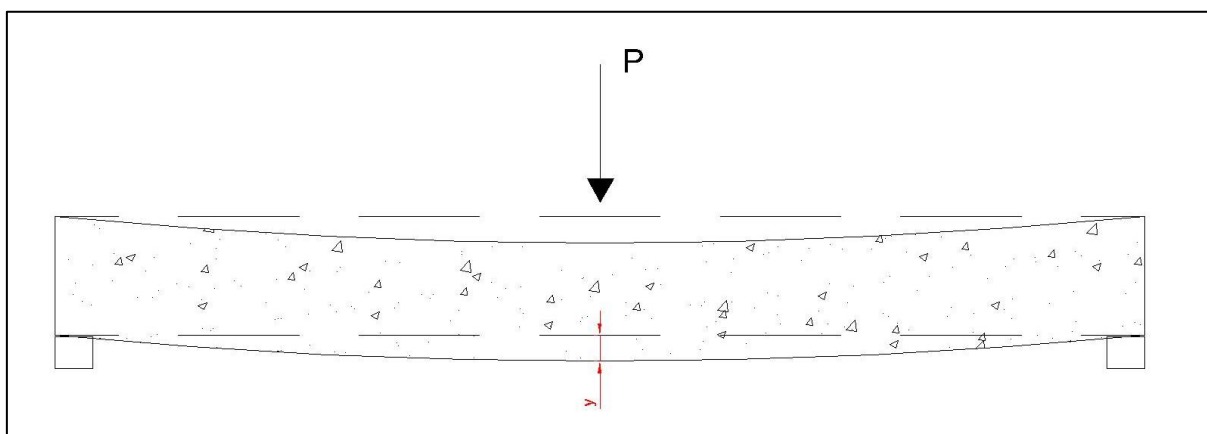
Esquema de ensaio à flexão de 3 pontos nas vigas do Grupo 2
